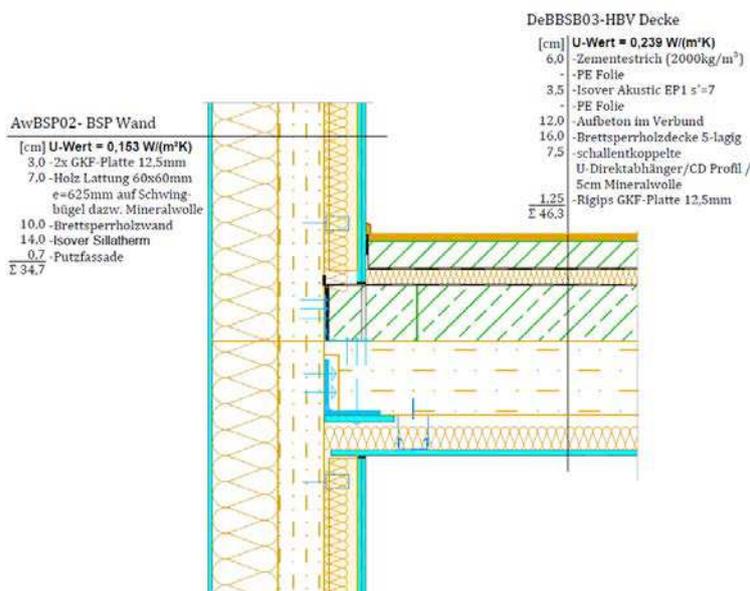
Anschlussdetail der tragenden Außenwand mit einer HBV-Decke
